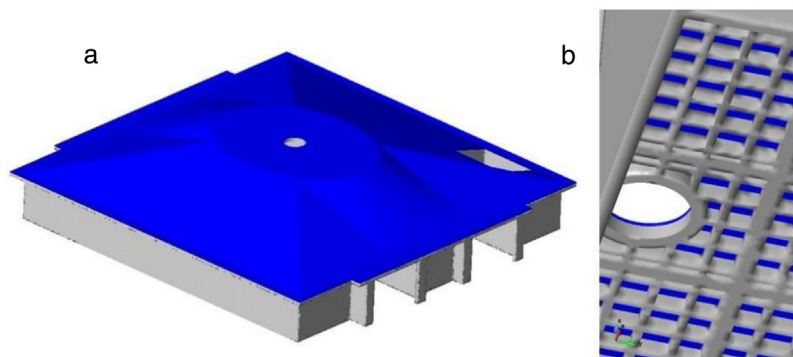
Losa reticular. a) Vista del conjunto; b) detalle de las nervaduras cercanas al lucernario.
